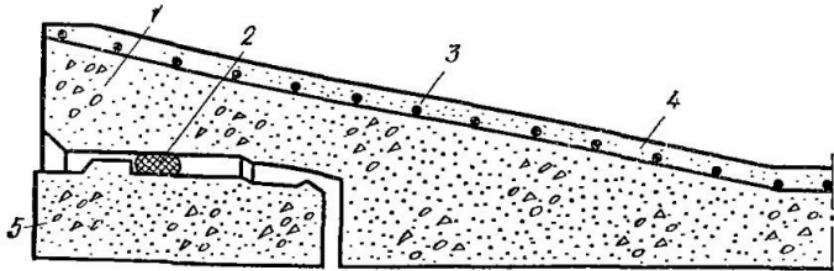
Стыковое соединение из железобетонных предварительно напряженных труб, изготавливаемых методом виброгидропрессования
